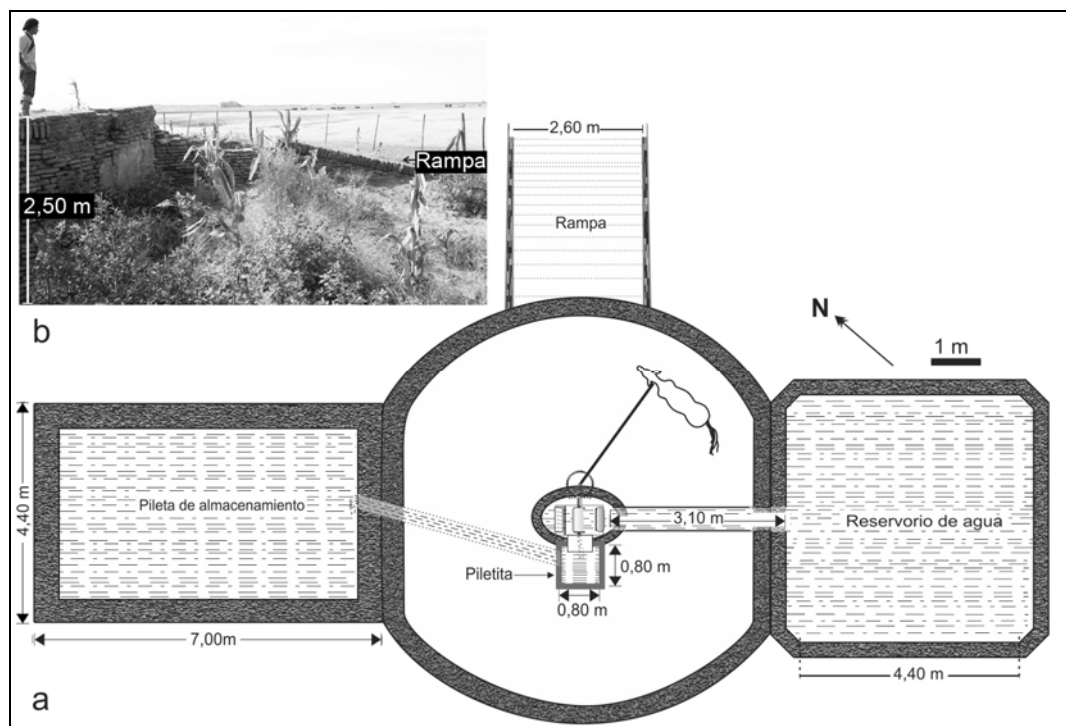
a, Emplazamiento de la noria vista en planta; b, Fotografía lateral de la rampa.
